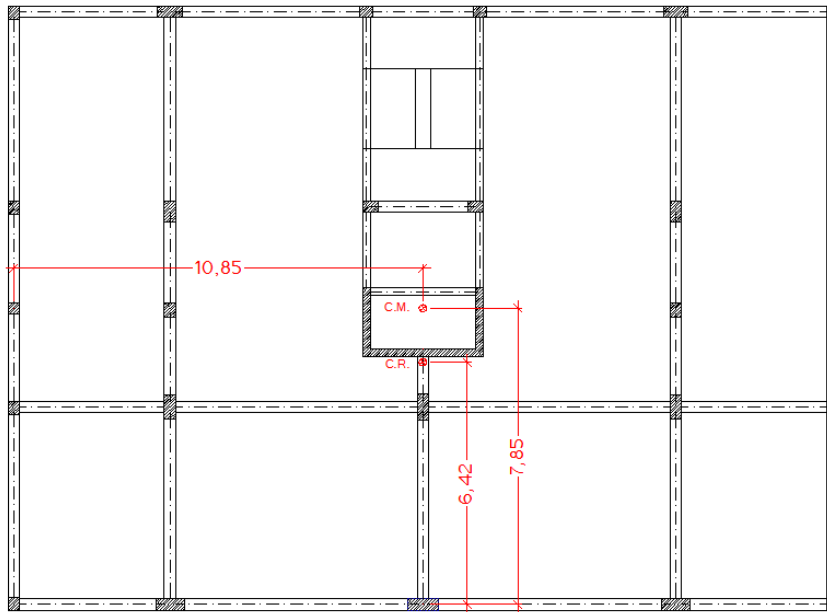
Identificação do centro de massa e de rigidez em planta do piso 1
